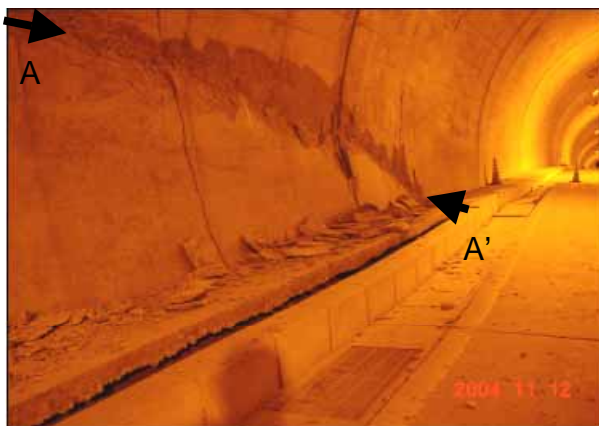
北側坑口から 75 m 地点の東側歩道の変状
